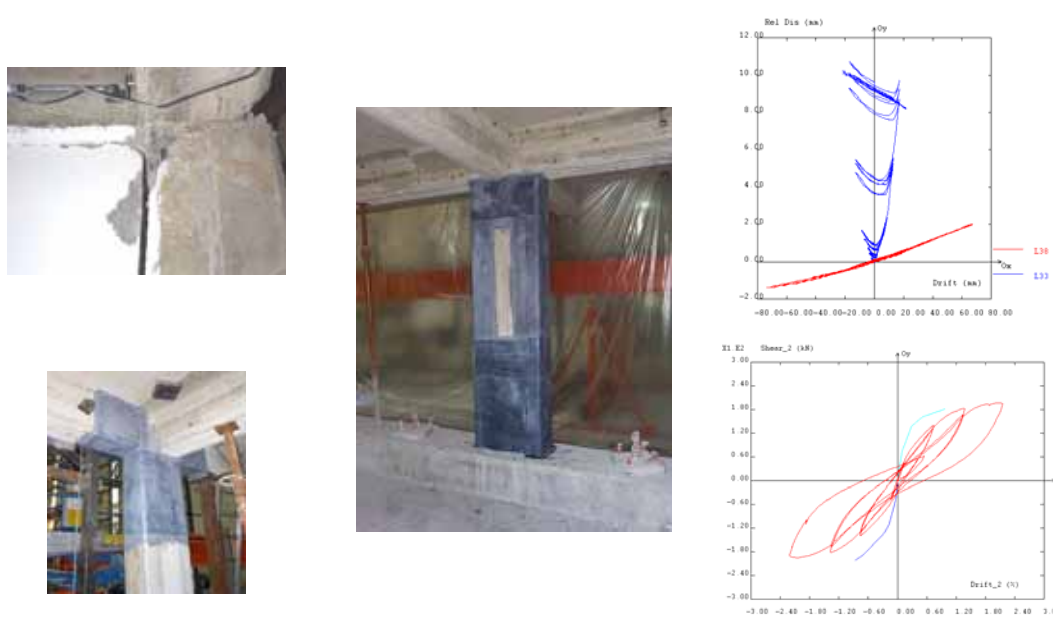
Colapso dos pilares exteriores (ligação pilar/nó); Pilar exterior reparado no topo; Pilar forte reparado ao nível do primeiro piso; Deslocamento lateral do topo do pilar exterior em relação ao nó viga-pilar; Resposta global ao nível do primeiro piso em termos de força de corte *versus* deslocamento de piso
